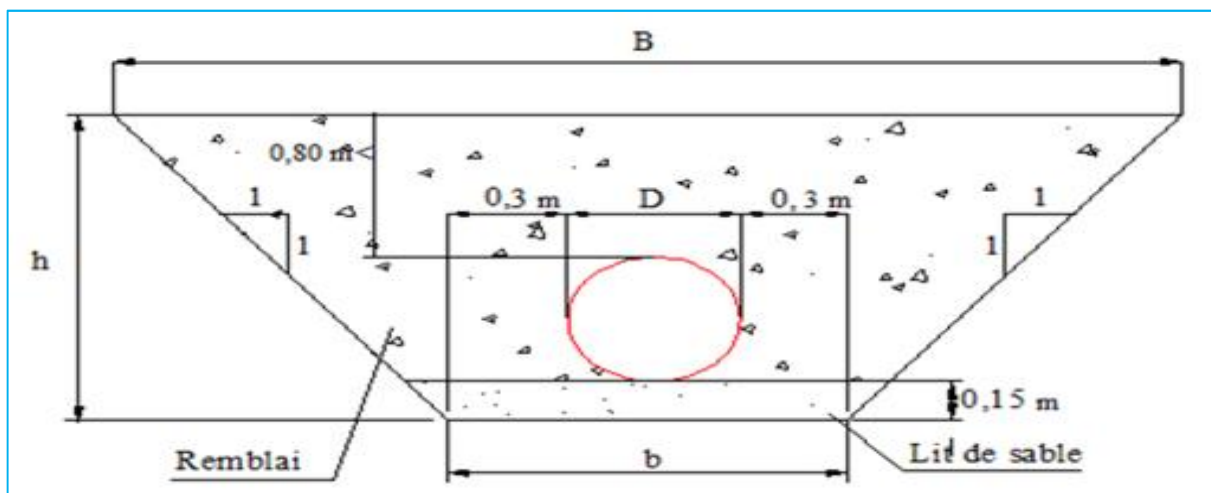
Coupes en travers de la tranchée de la conduite
